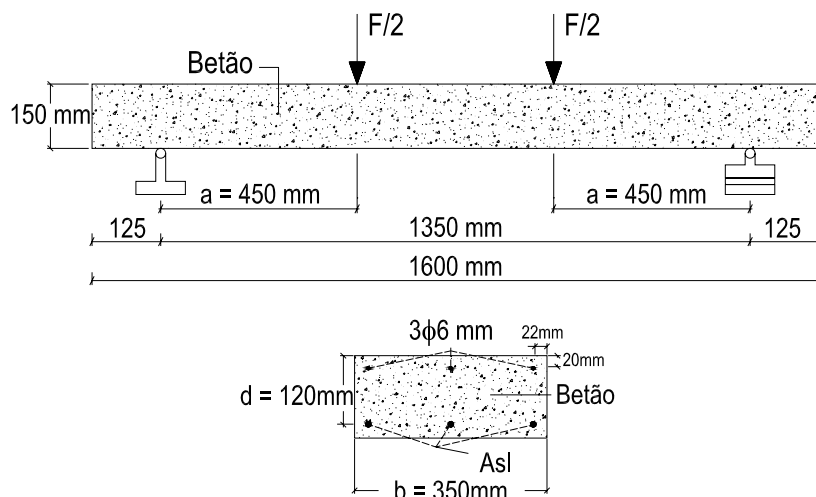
Representação das secções longitudinal e transversal da faixa de laje tipo a ensaiar
